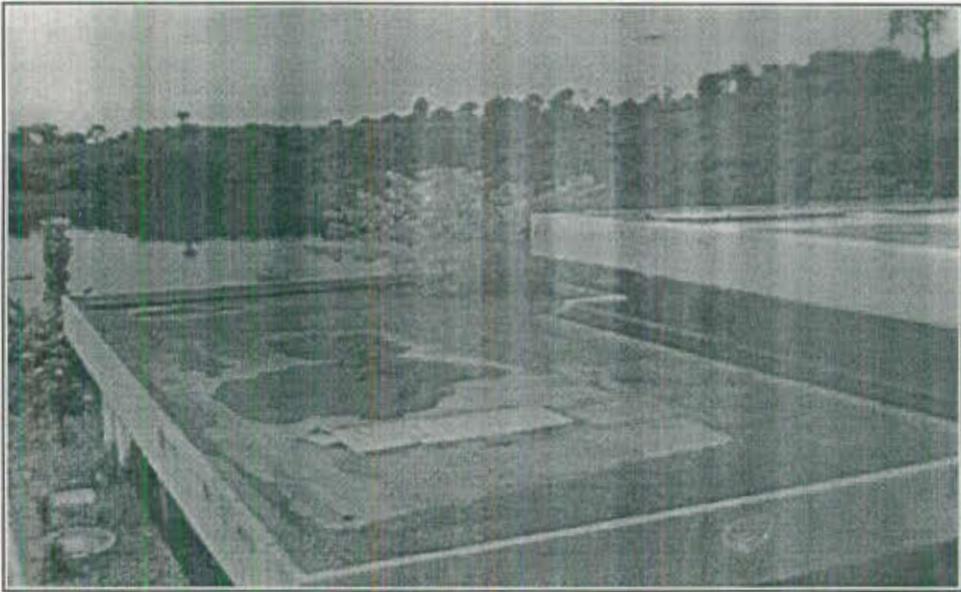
VISTA DE LOSA DE CUBIERTA DE LABORATORIO DE CRUSTACEOS (LAB. DE ACUIC.) DE F.I.M.C.M.
